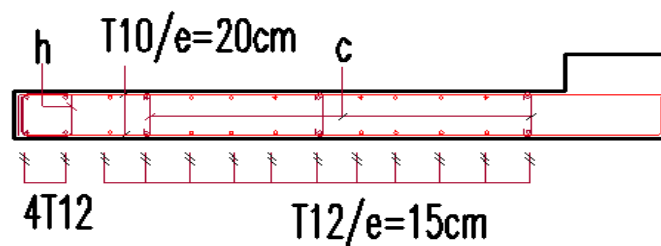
Schéma de ferrailage de du voile Vx1 (11ème-12ème)
